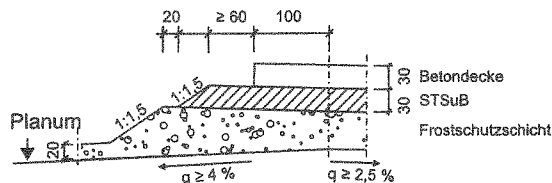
Randausbildung einer Betondecke auf einer Schottertragschicht (STSüB)
